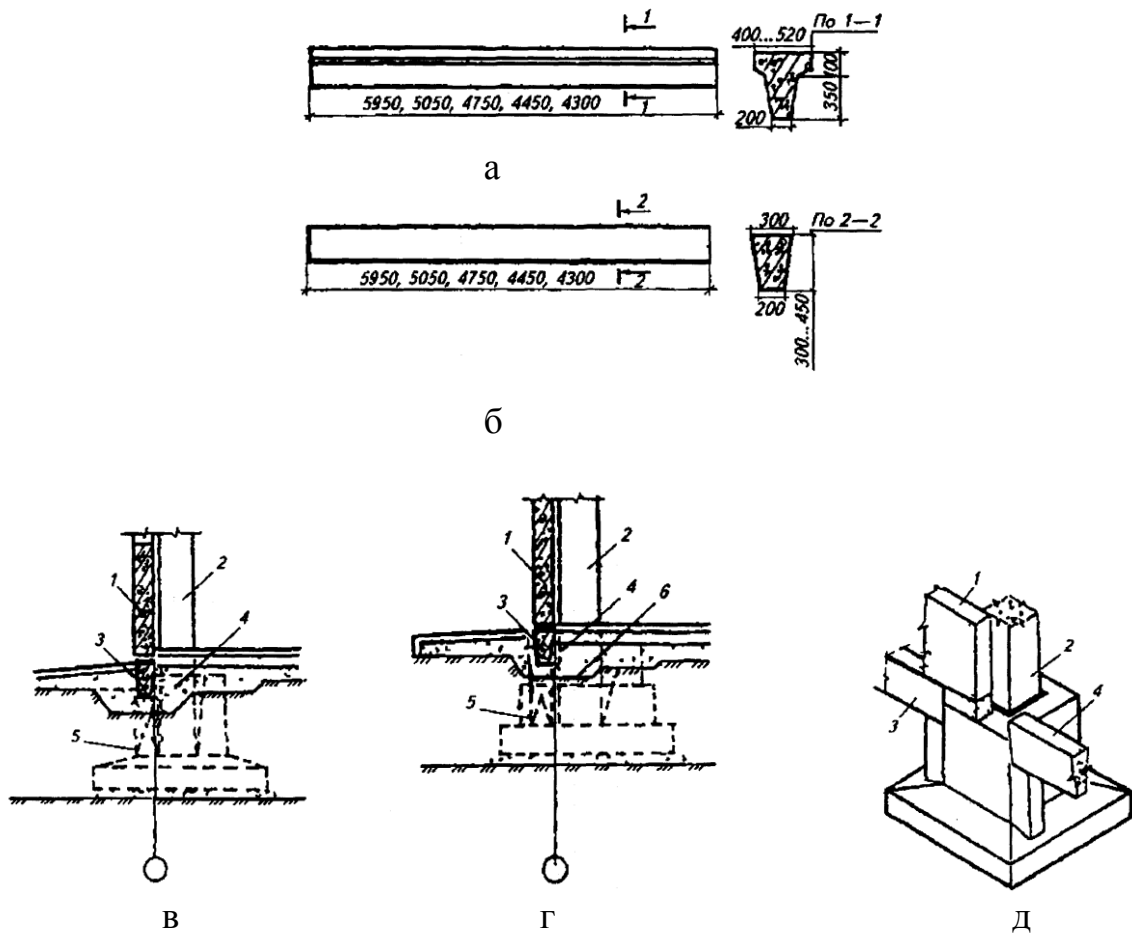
Железобетонные фундаментные балки с деталями их укладки:
